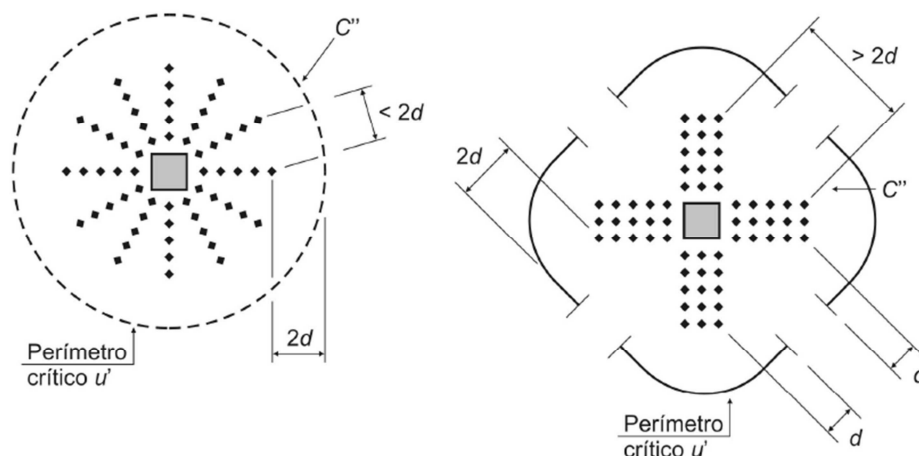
Disposição da armadura de punção em planta e contorno da superfície crítica C'' (NBR 6118: 2007)
